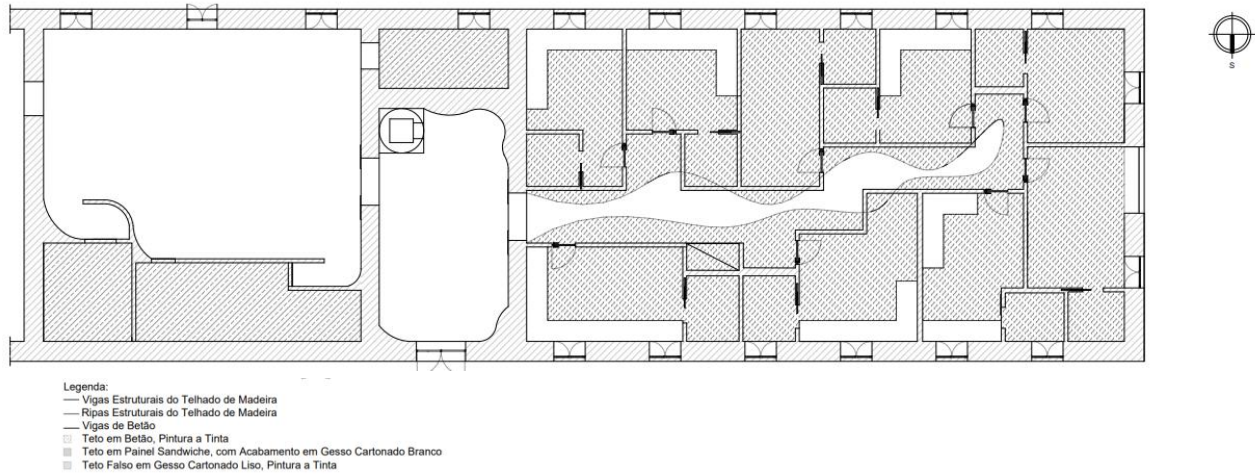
Planta de Tetos, Piso 0, Alojamento Olive
